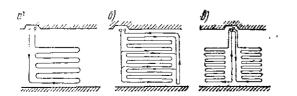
Размещение змеевиков из труб в междуэтажных перекрытиях
